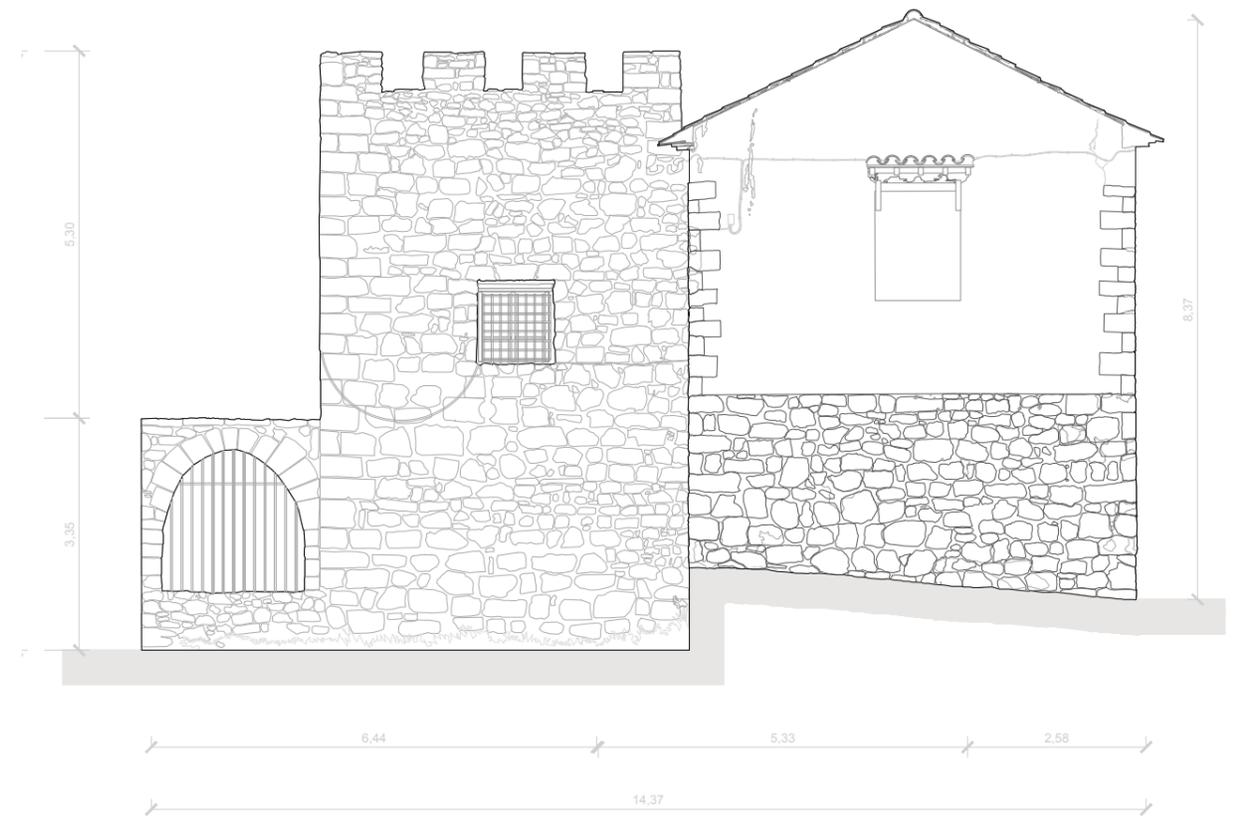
Alzado Sur Esc. 1:100. (elaboración propia)
